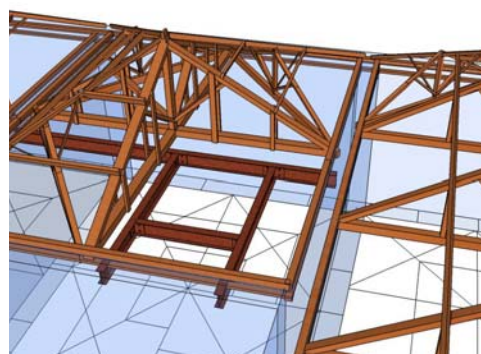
Detalhe 5, inclusive estrutura metálica do elevador existente.
